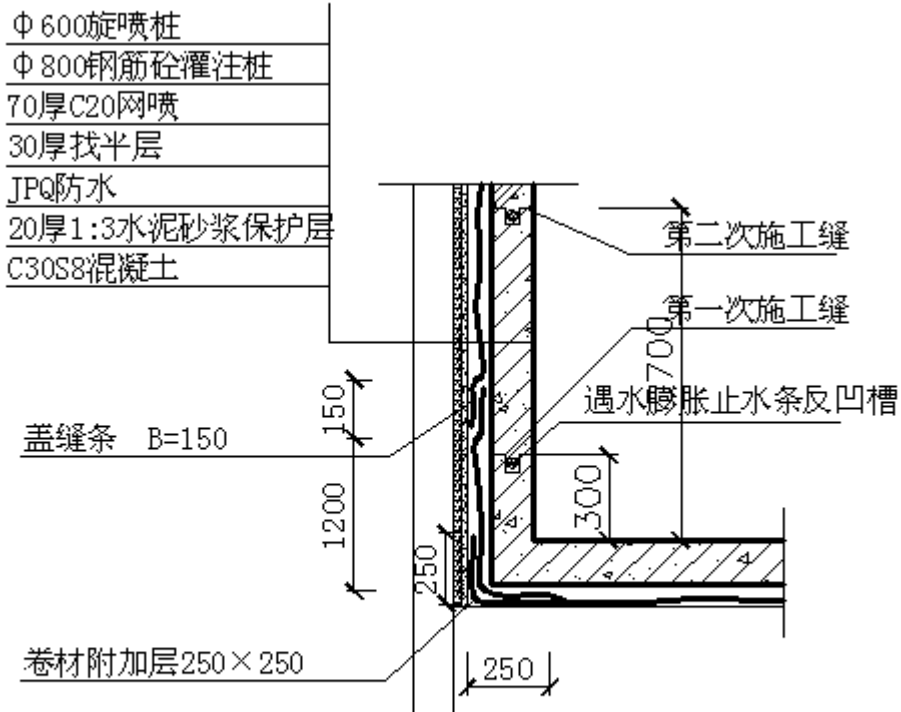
地板、侧墙及施工缝留设部位防水示意图
